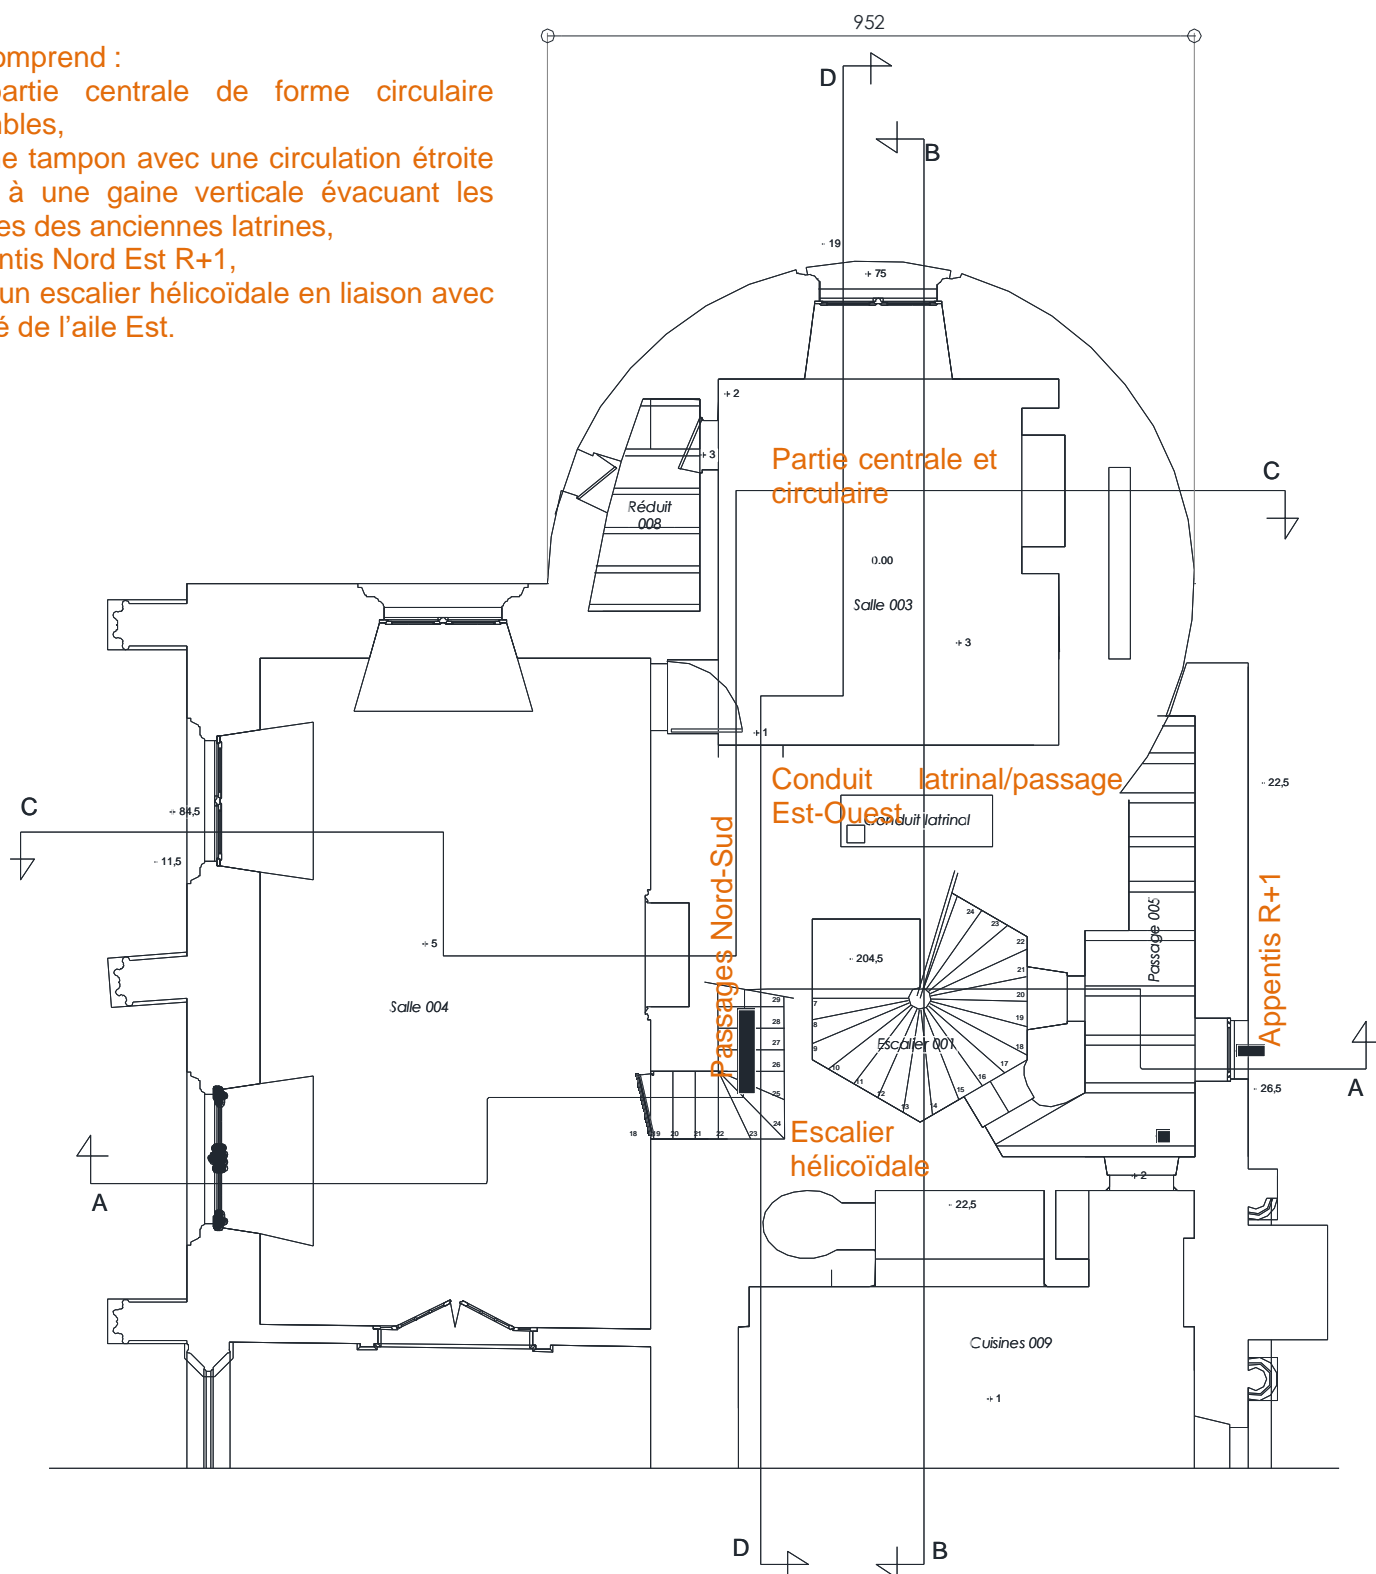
Vue en plan du RdC - Enchevêtrement des murs de la tour et de l'aile Est - Extrait plan O.Salmon – ACMH
